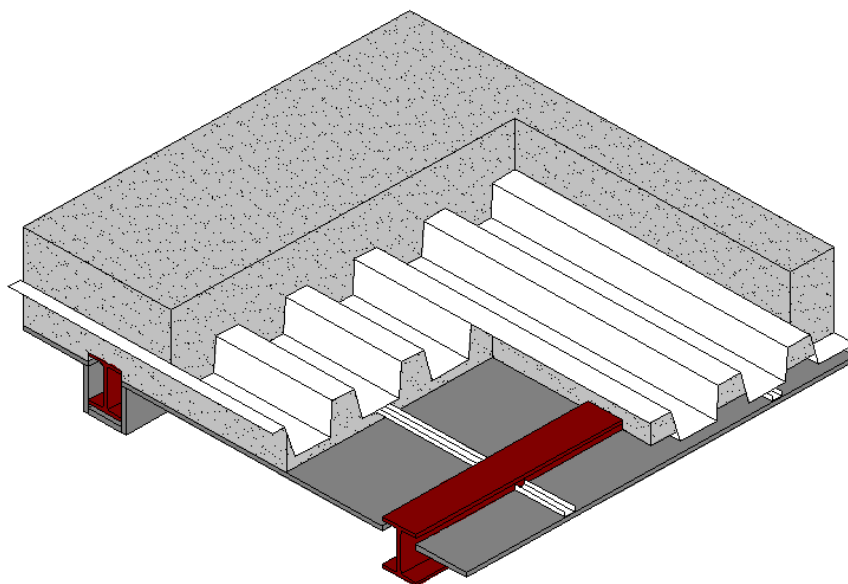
Междуэтажное перекрытие с несущим профилированным листом
